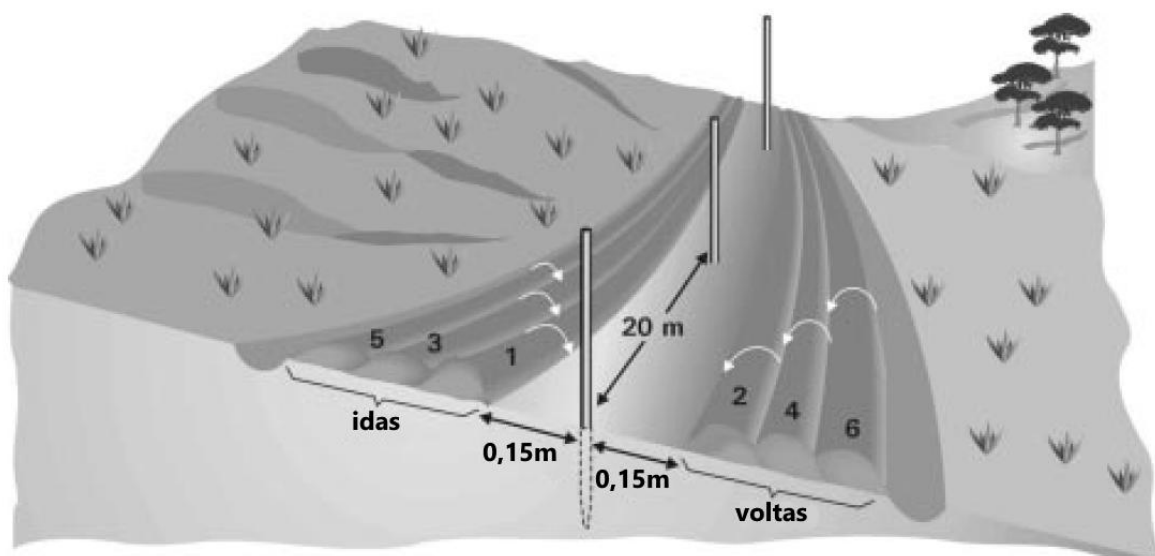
Ilustração da construção de terraço de base média, demonstrando o posicionamento das estacas e a primeira série do esquema de passadas do trator para levantamento do camalhão.
